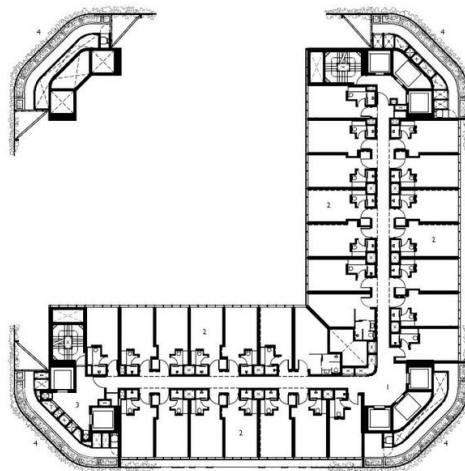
Denah Lantai 12 Oasia Hotel, Singapura
